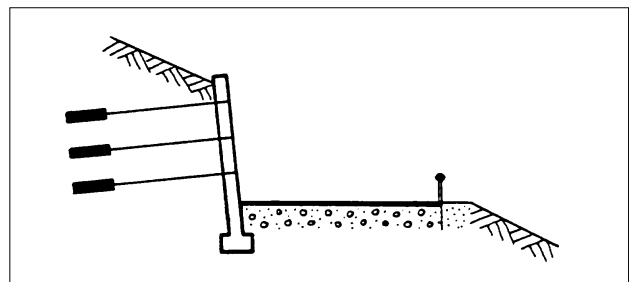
Rückverankerte Stützmauer in Stahlbeton:
